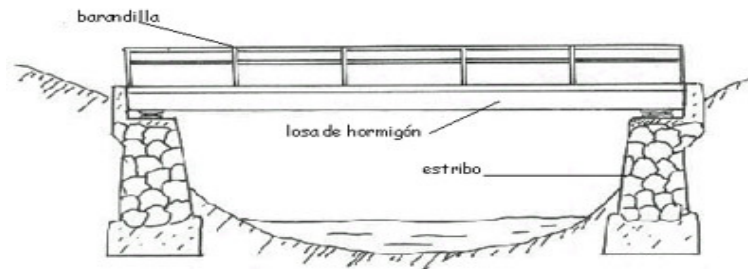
Esquema longitudinal. Ingrid Raventós (2000).
